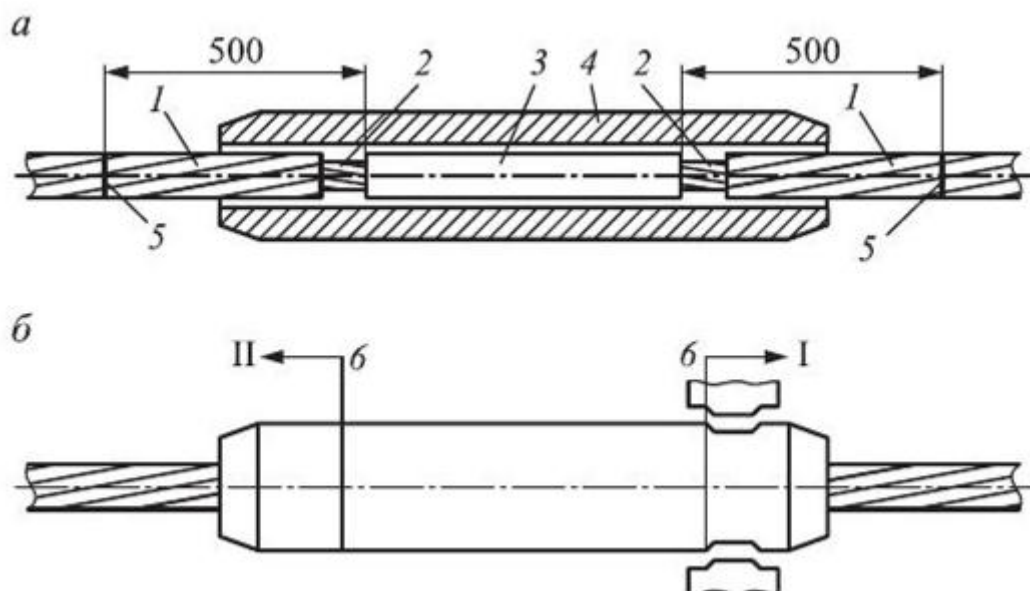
Схема соединения сталеалюминевых проводов площадью поперечного сечения 240 мм² и более с помощью прессуемых соединителей: а - установка корпуса соединителя; б - опрессовка корпуса; 1 - соединяемые провода; 2 - обнаженный стальной сердечник; 3 - стальная гильза; 4 - алюминиевый корпус; 5 - метки на проводах; 6 - положение стального сердечника; I, II направления опрессовки алюминиевого корпуса жил стальной сердечник провода. Для этого верхние по- вивы алюминиевых проволок отрезают, а нижние отгибают, надпиливают до половины ножовкой и обламывают. Концы стальных проволок сердечников соединяемых проводов зачищают напильником, удаляя заусенцы. Затем сердечник очищают, промывают бензином, вытирают насухо и смазывают защитной электросетевой смазкой или тех ни ческим вазел ином.
